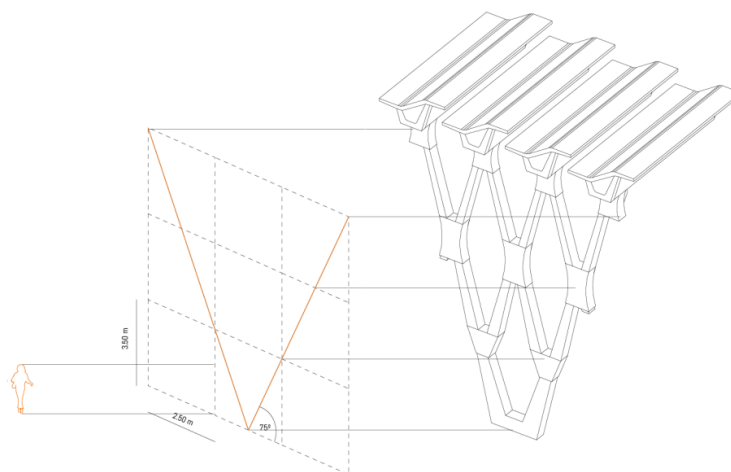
Modulación y geometría de fachada. Fuente: Elaboración propia.
